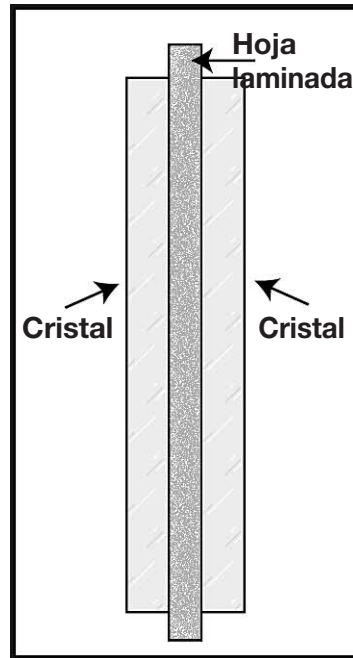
Esta ilustración muestra la construcción básica del cristal laminado.
